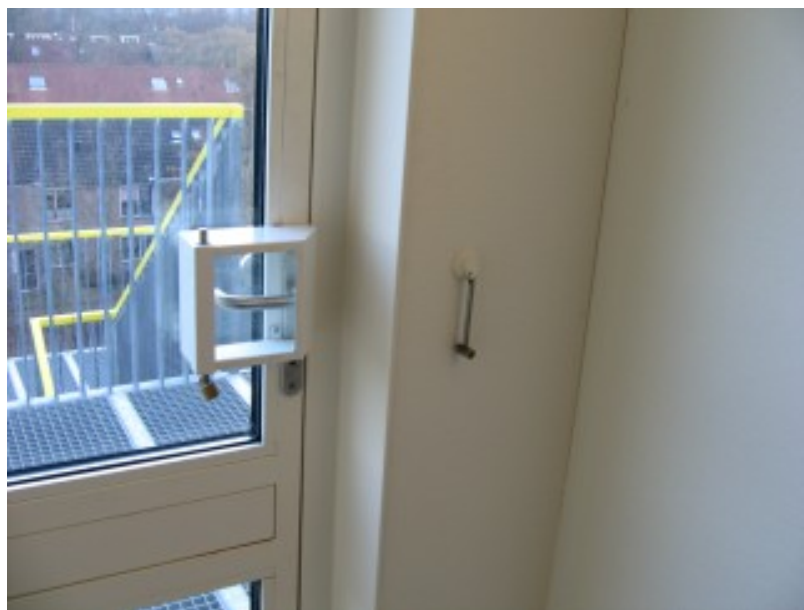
Niet zonder losse voorwerpen te openen nooddeur.
